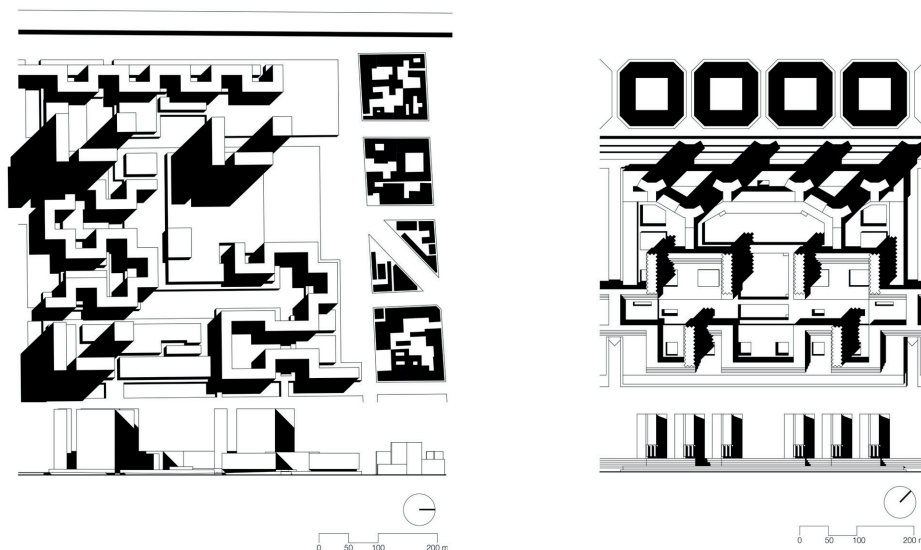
Le supermanzanas di Antoni Bonet Castellana. Plan de Urbanización Barrio Sur e Plan de Ordenación de la Ribera. Fonte: elaborazione dell'autore.
